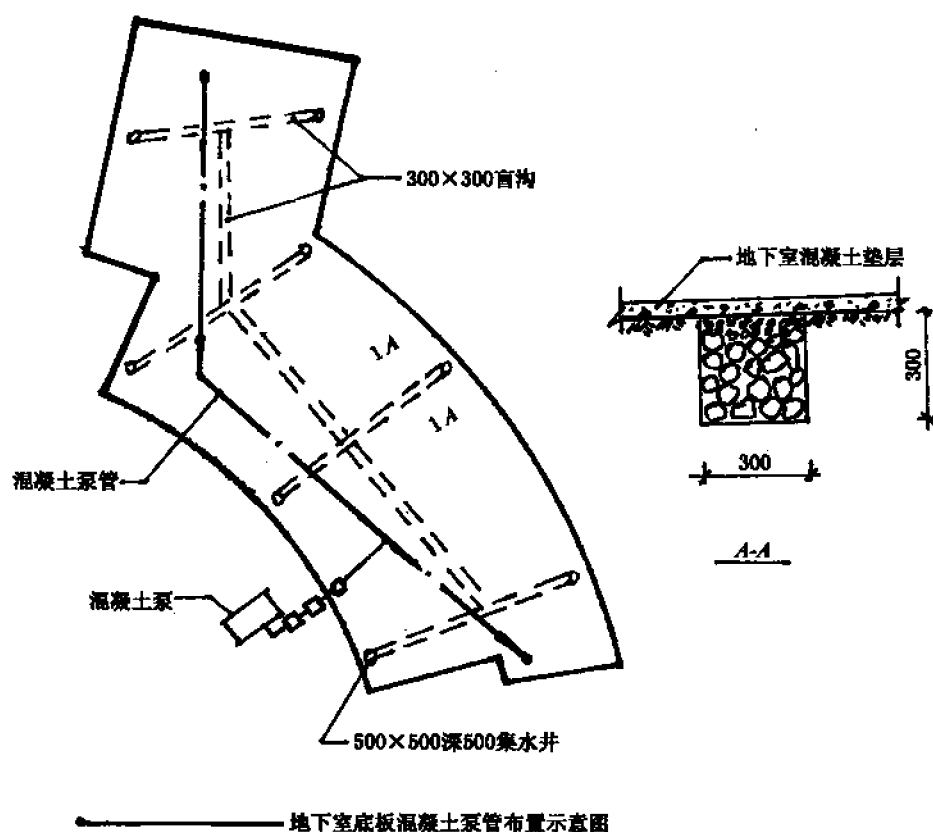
基坑盲沟设置及地下室底板混凝土泵、管布置示意图
